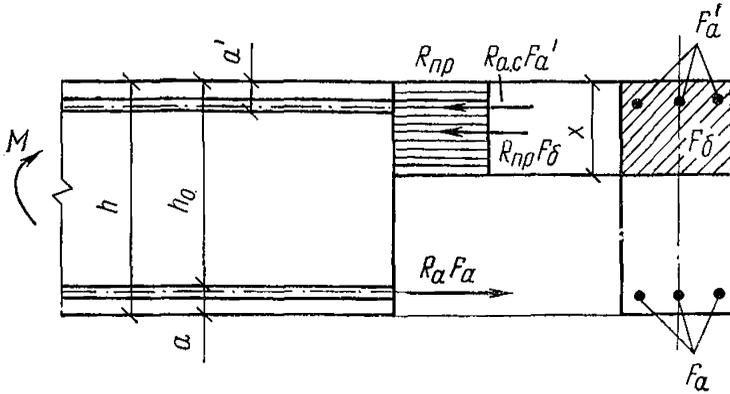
Схема усилий и эпюра напряжений в сечении, нормальном к продольной оси изгибаемого железобетонного элемента, при расчете его по прочности
